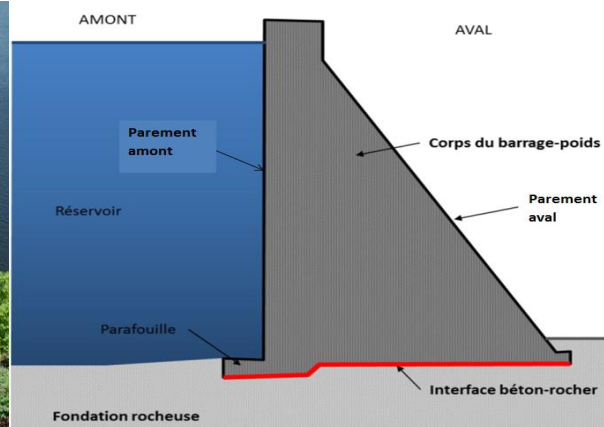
Coupe transversale schématique d'un barrage-poids
